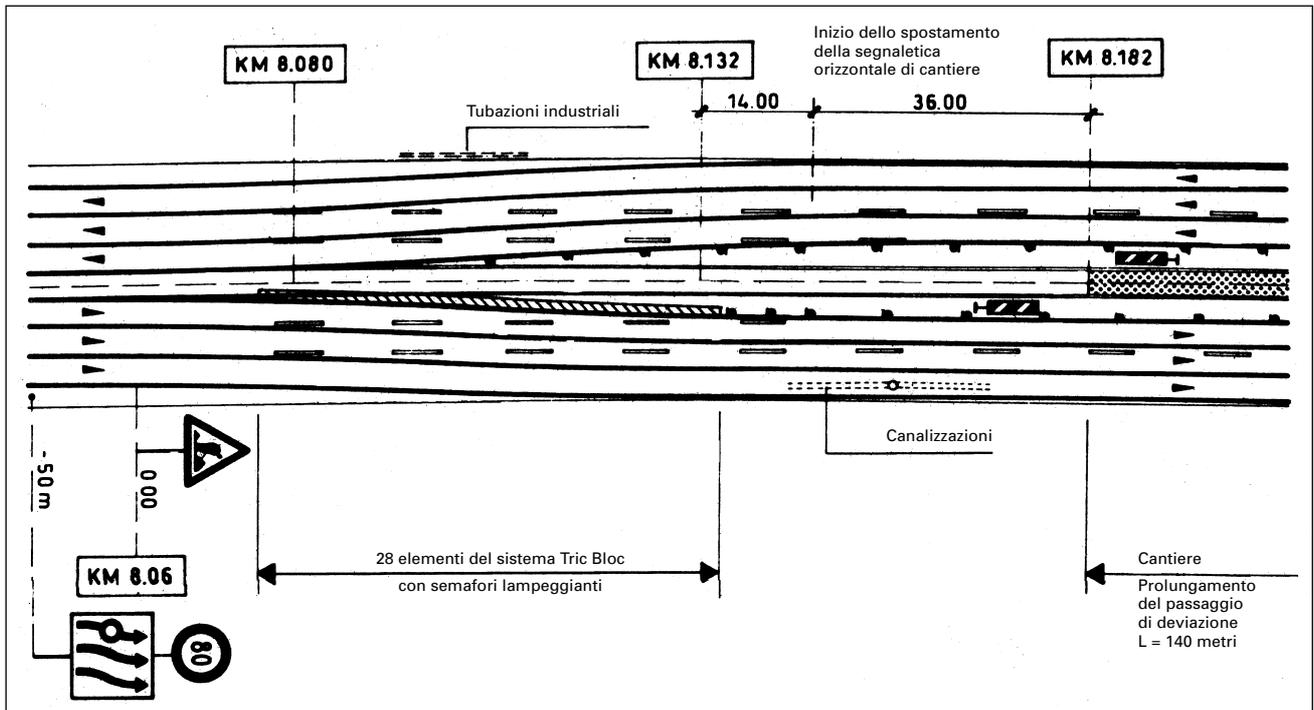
piano di segnaletica e segnaletica orizzontale per un cantiere protetto dagli elementi Tric-Bloc
